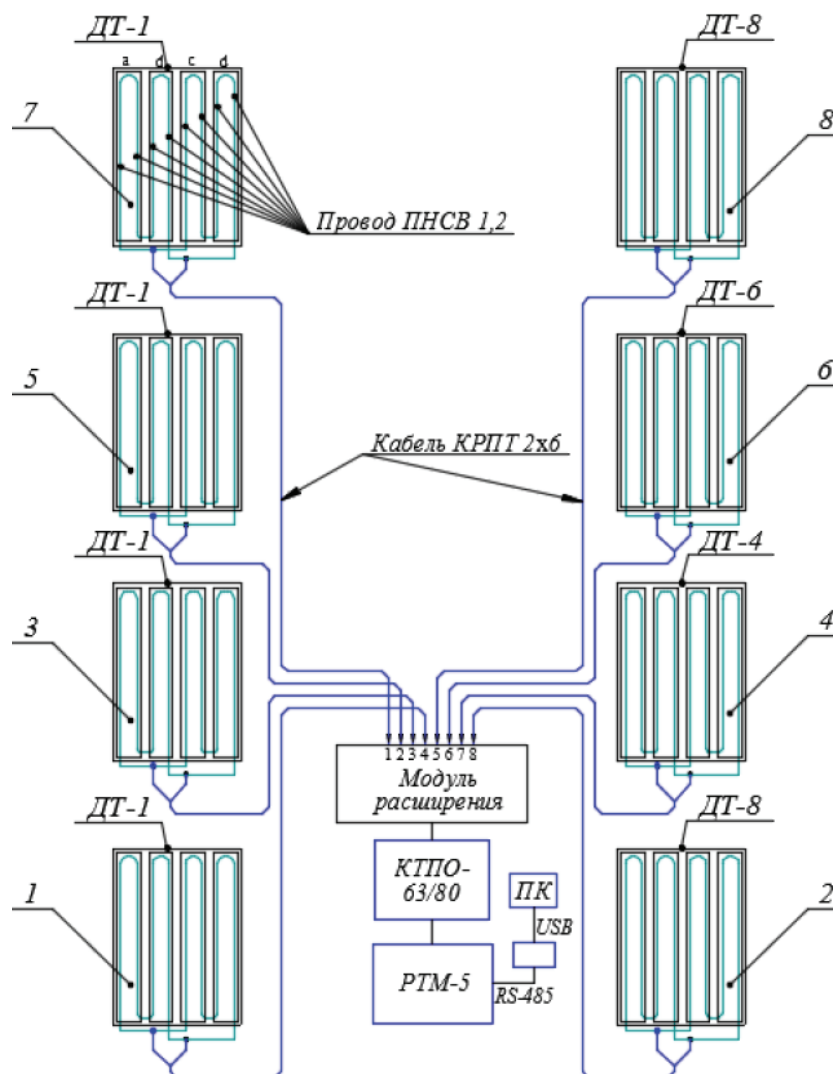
Схема раскладки и подключения нагревательного провода при термообработке бетона.
